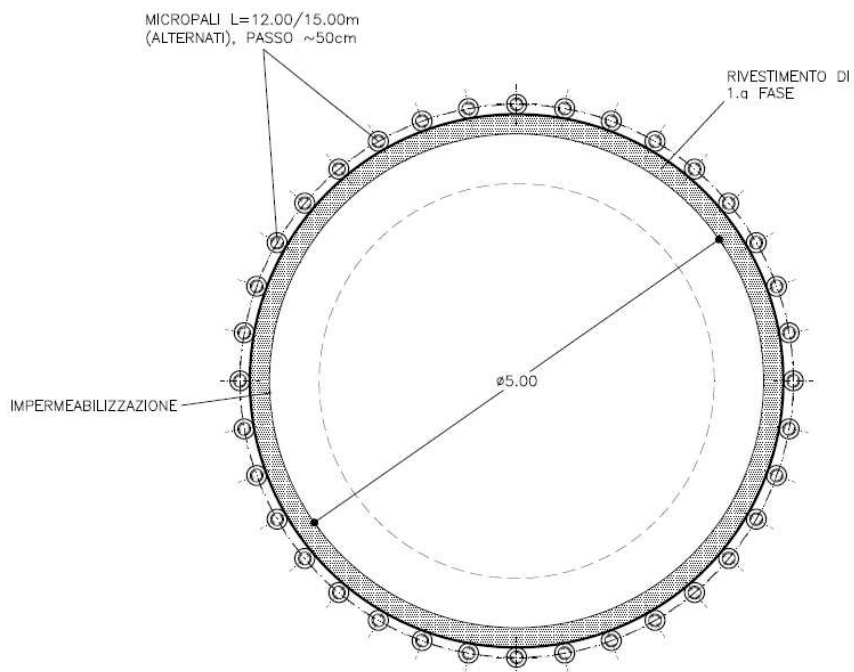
Pozzo di accesso alla cabina TE: sezione in pianta 1 di 2
